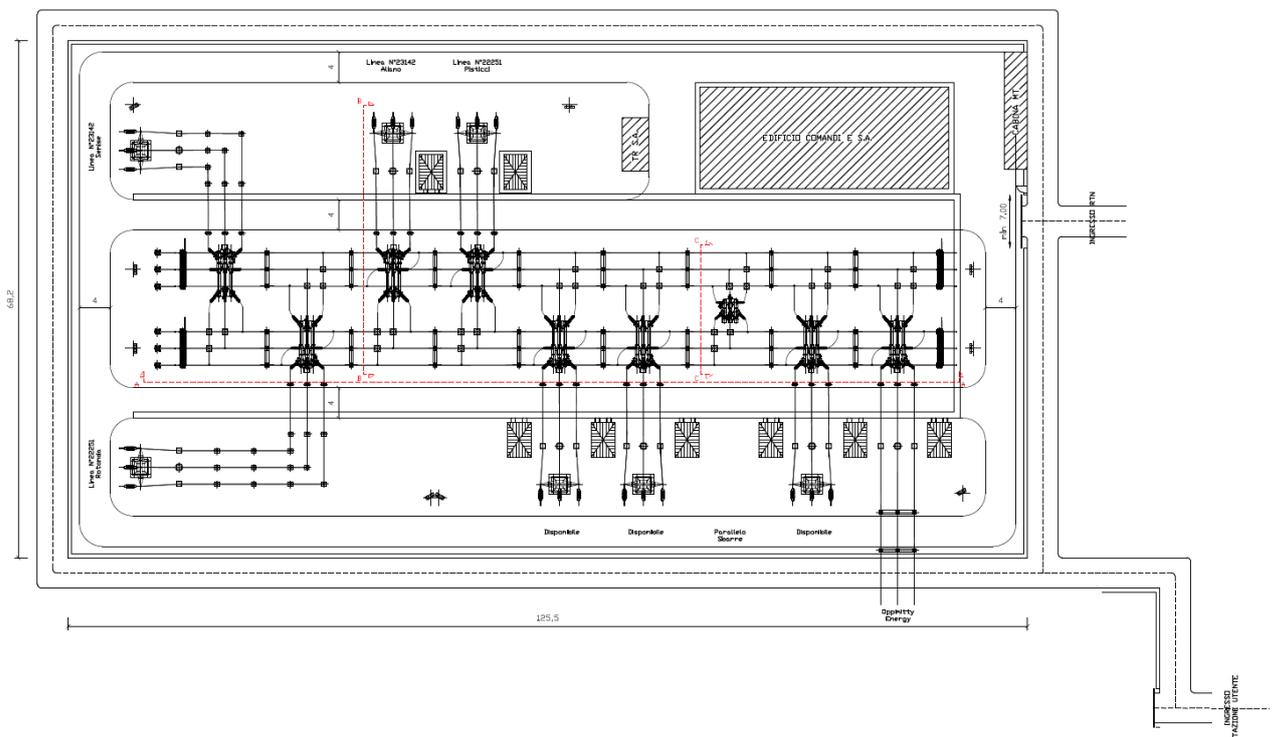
Planimetria nuova stazione elettrica di Sant'Arcangelo con ubicazione dell'assegnazione degli stalli
